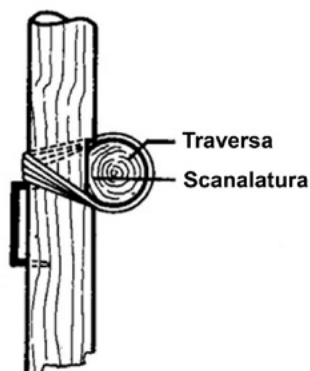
Fissaggio sicuro della traversa al palo del cavalletto (USTRA)
